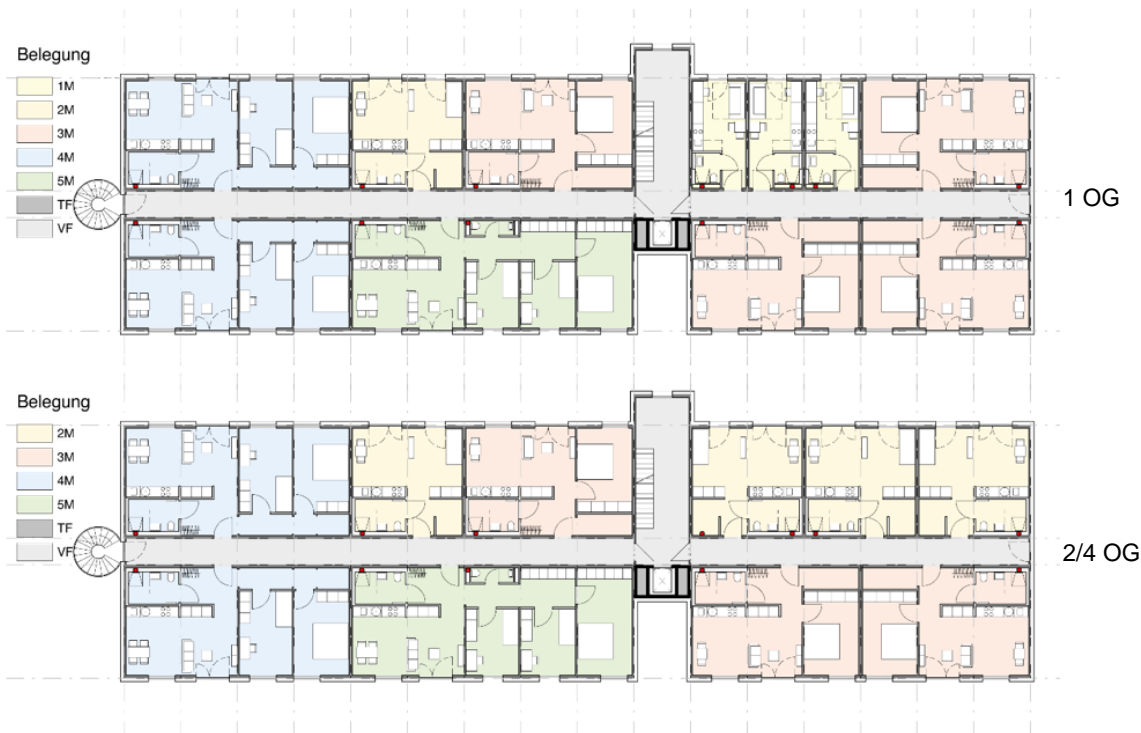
Referenzgebäude Suffizienz V1, Grundrisse 1 und 2/4 OG
